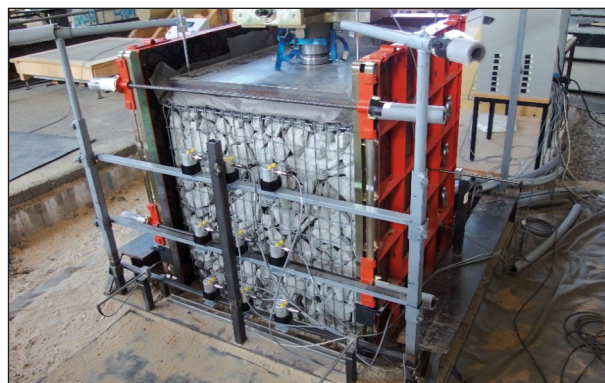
Versuch 7 – Befüllte Gabione ohne eingeschweißte Kraftsensoren
